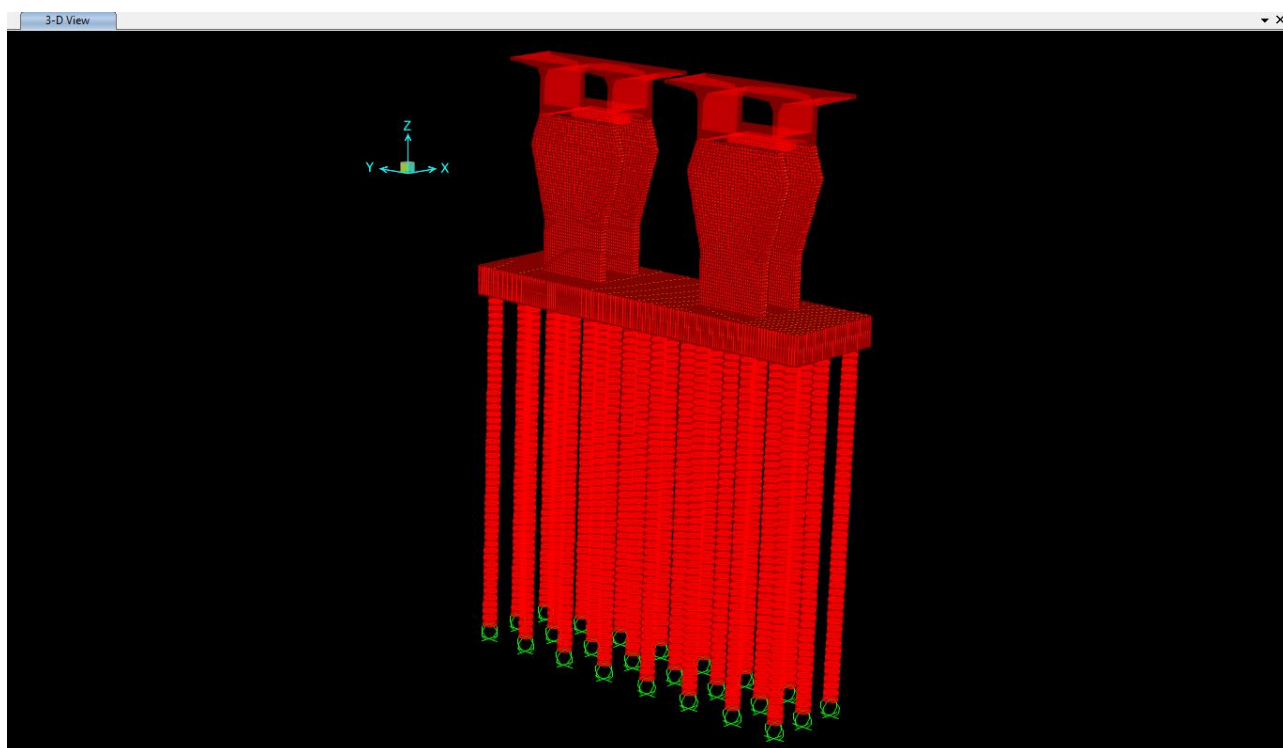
Vista pila centrale con tratto soprastante impalcato
